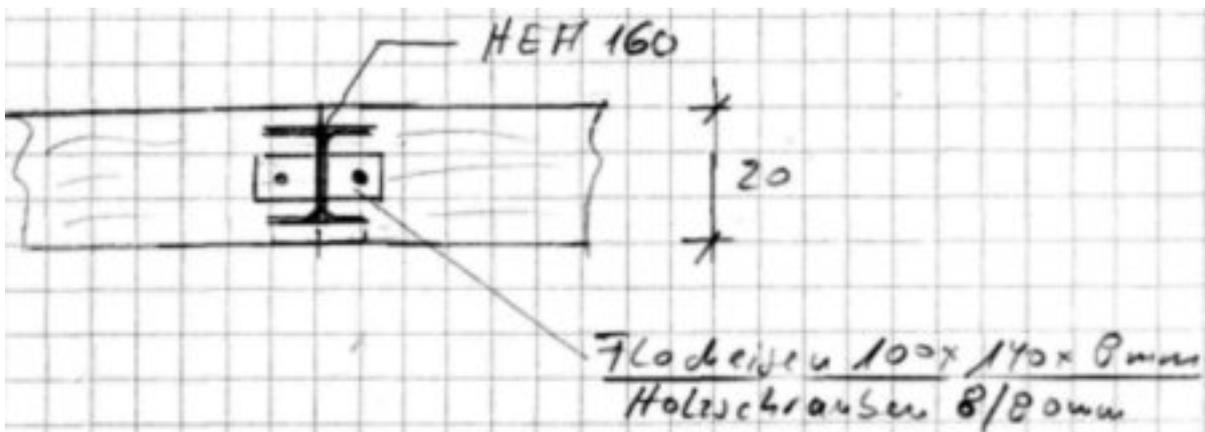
Anschluss Dachsparren an Unterzug HEA 160, Cramer Engineering
